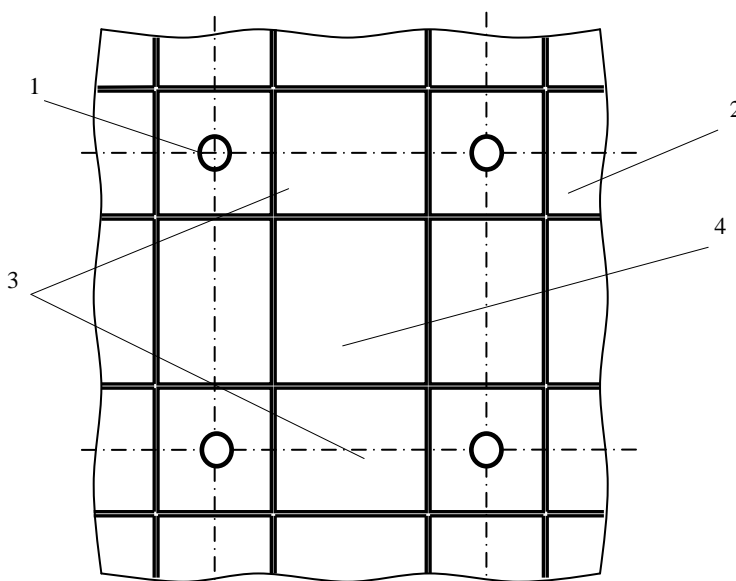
Схема збірного сталезалізобетонного безбалкового перекриття:
